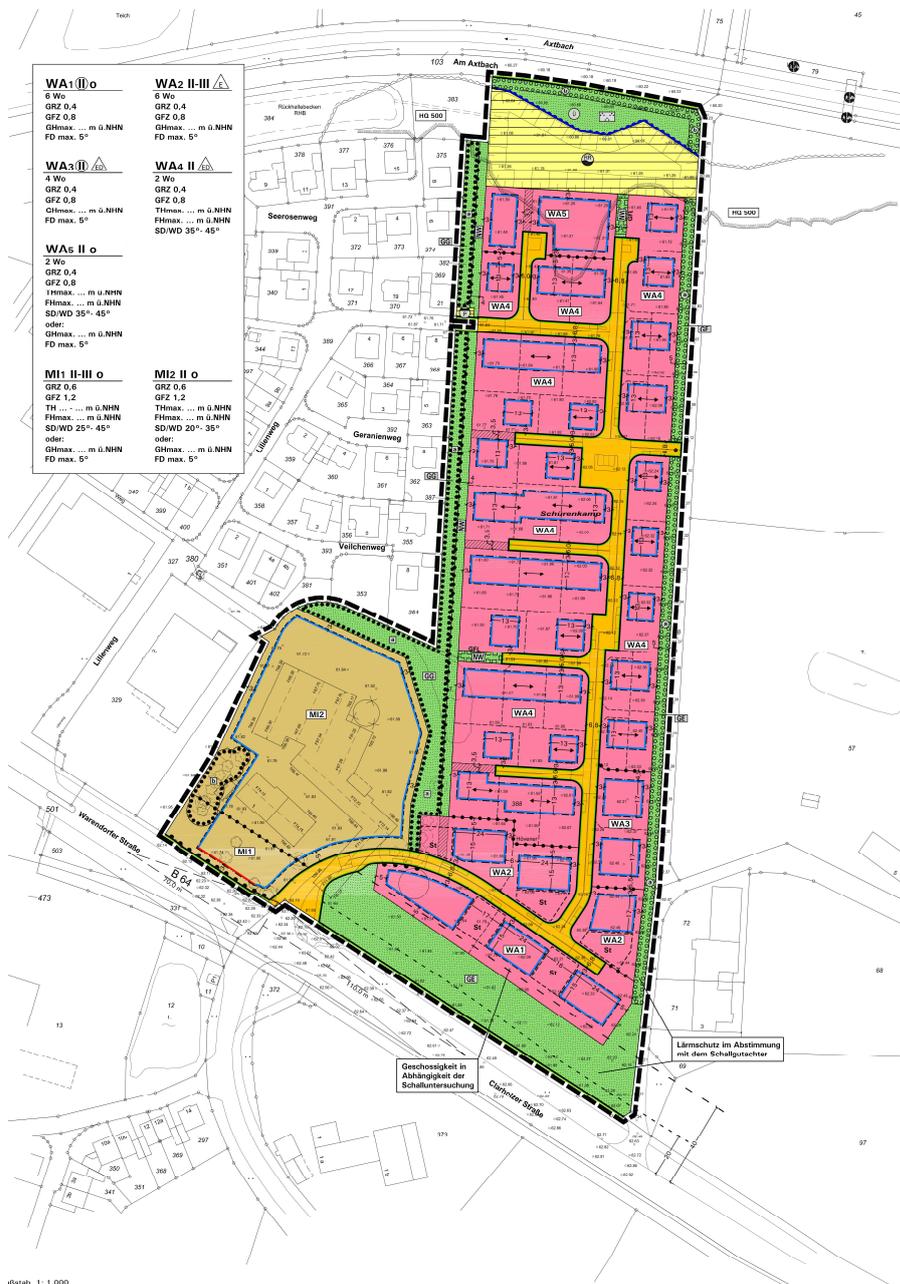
Übersicht Vorentwurf Bebauungsplan
